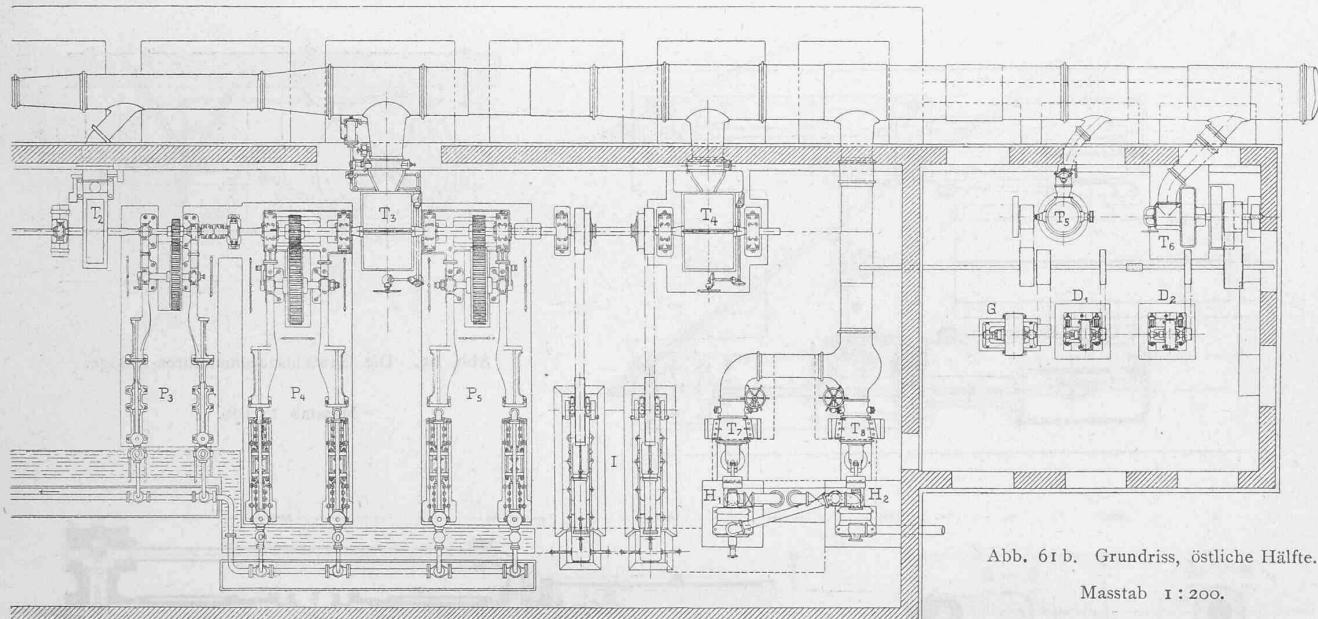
Grundriss, östliche Hälfte.
